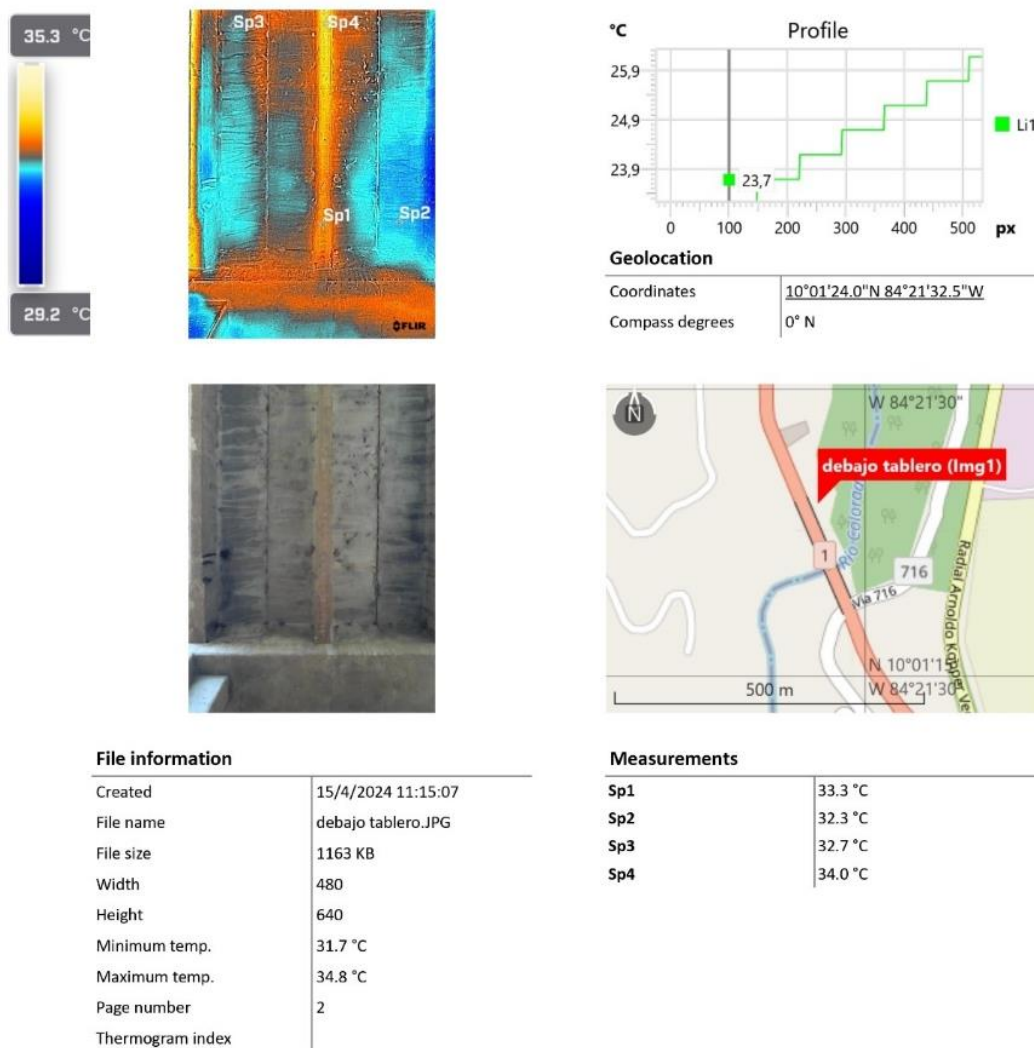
29 Reporte térmico de eflorescencias en vigas principales de la sección No. 8
